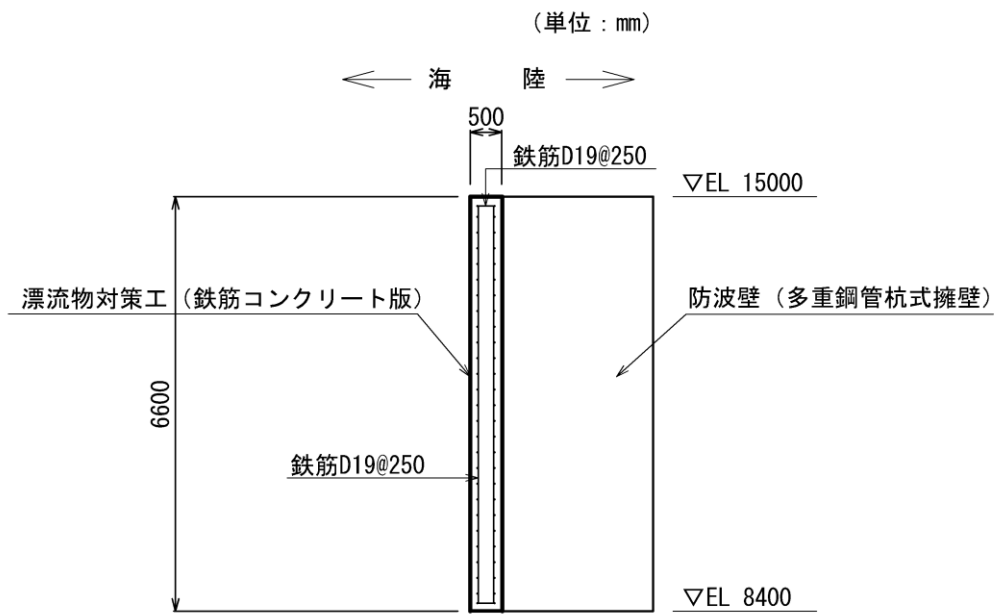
(2) 漂流物対策工 (鉄筋コンクリート版) の概略配筋図 (断面図)
